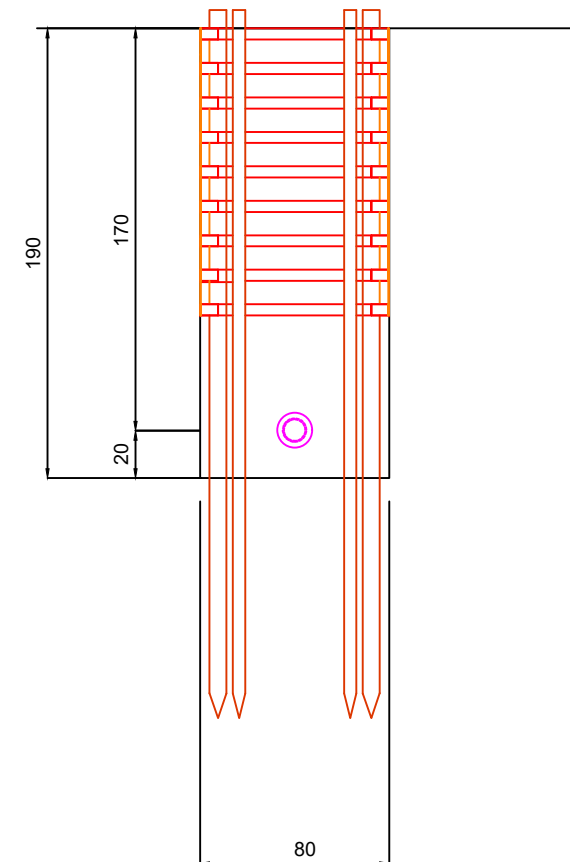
DETAIL PEMASANGAN TURAP PENAHAN TANAH PIPA CROSSING
